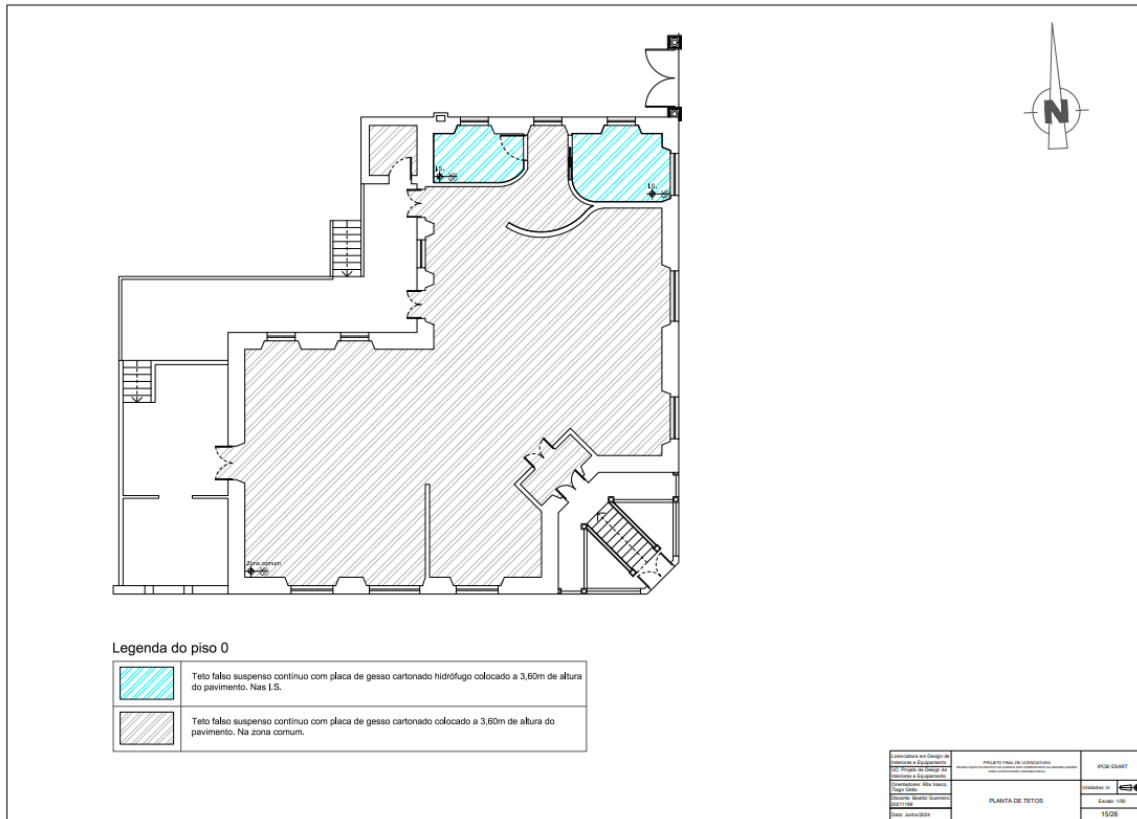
Planta de Tetos, piso -1, sem escala. Fonte: Autor
